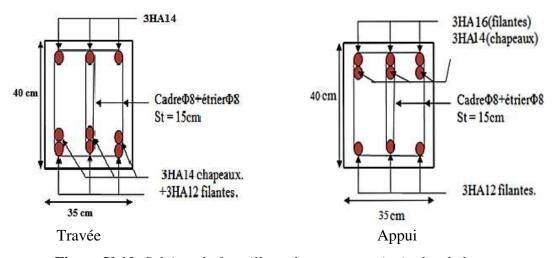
Schéma de ferraillage des poutres principales de la terrasse.
